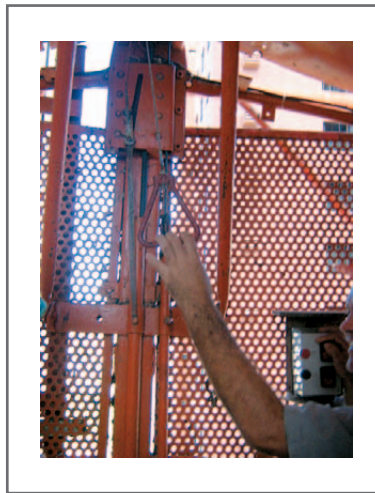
Freio do elevador de passageiro (atividade de construção)
